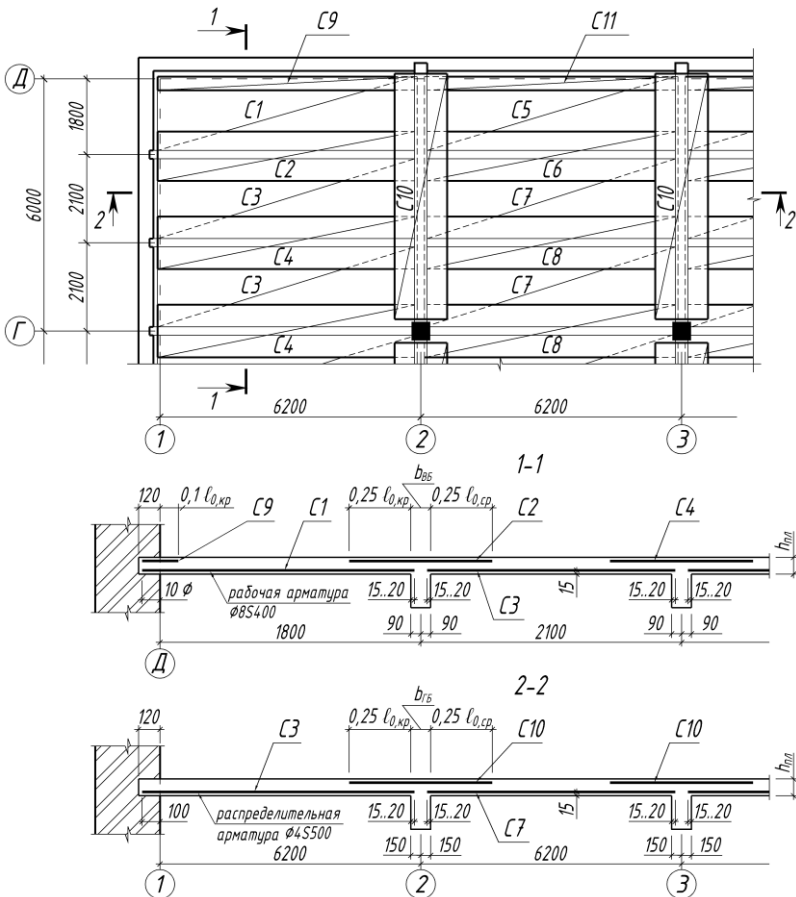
Схема принятой арматуры для крайнего пролета плиты
